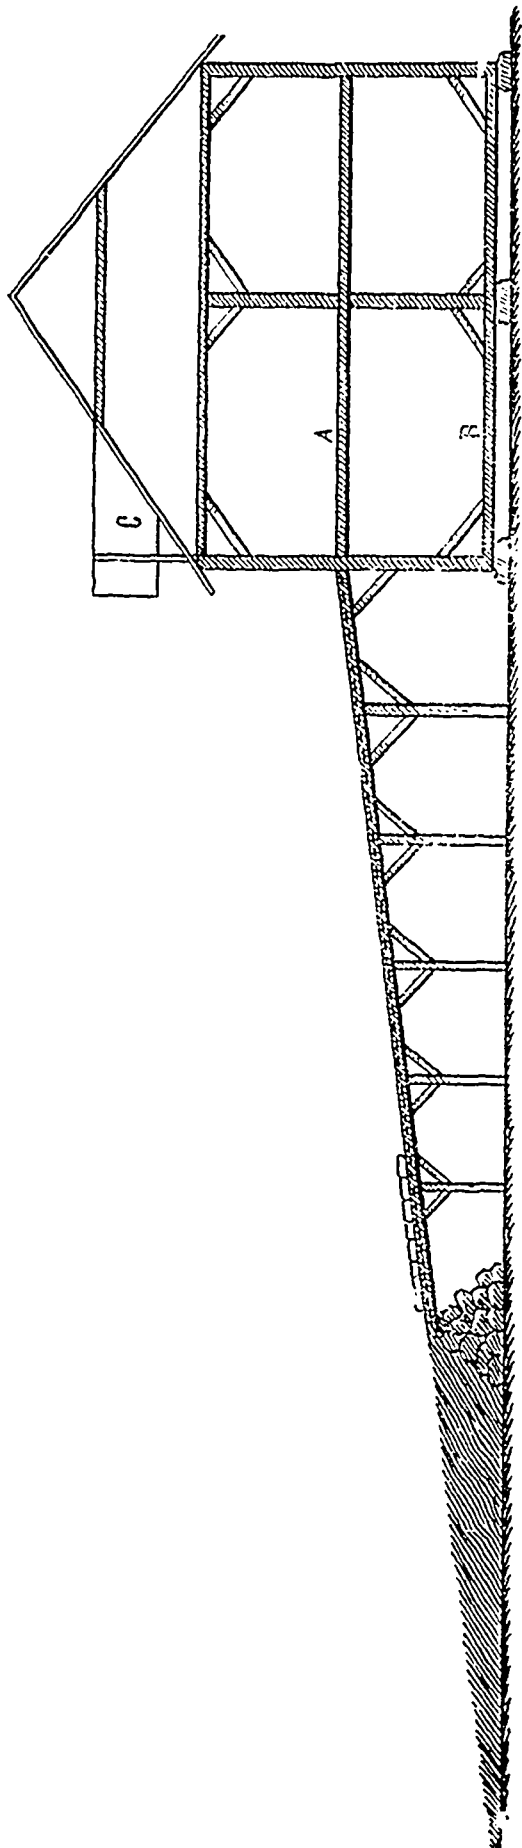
Même bâtisse vue de côté, avec montée aux batteries d'un pied de hauteur sur huit de longueur.
